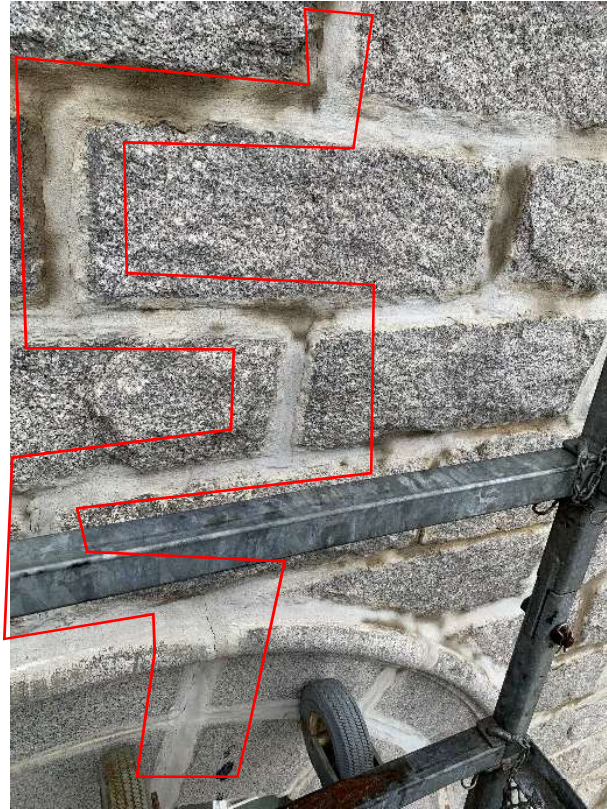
Propagation de la fissure jusqu'à la l'arche de la fenêtre sous-jacente
